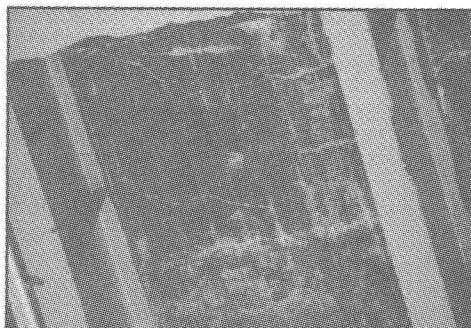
ひび割れ・遊離石灰状況(床版 2)
